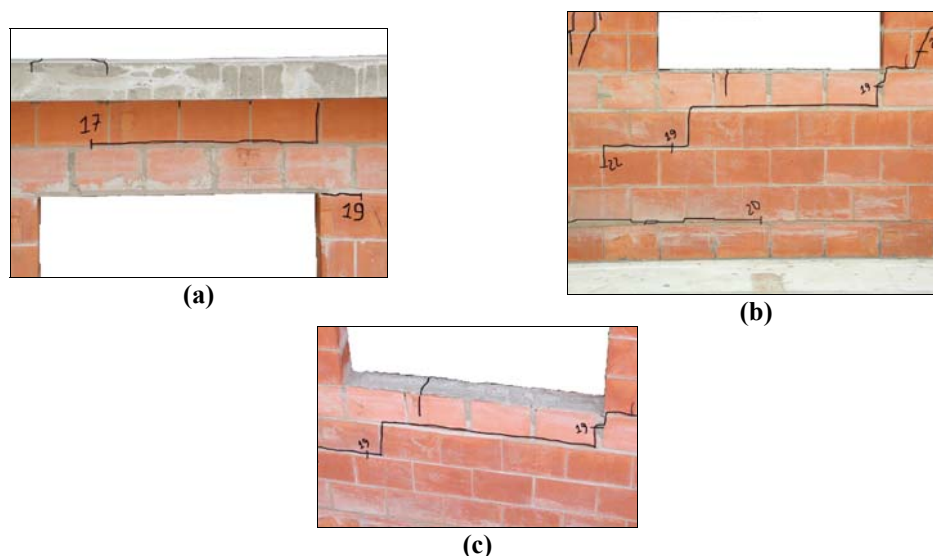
Fissuração dos lintéis do modelo PJSG1: (a) Lintel superior; (b) Lintel inferior e (c) Detalhe da fissura na contraverga.
